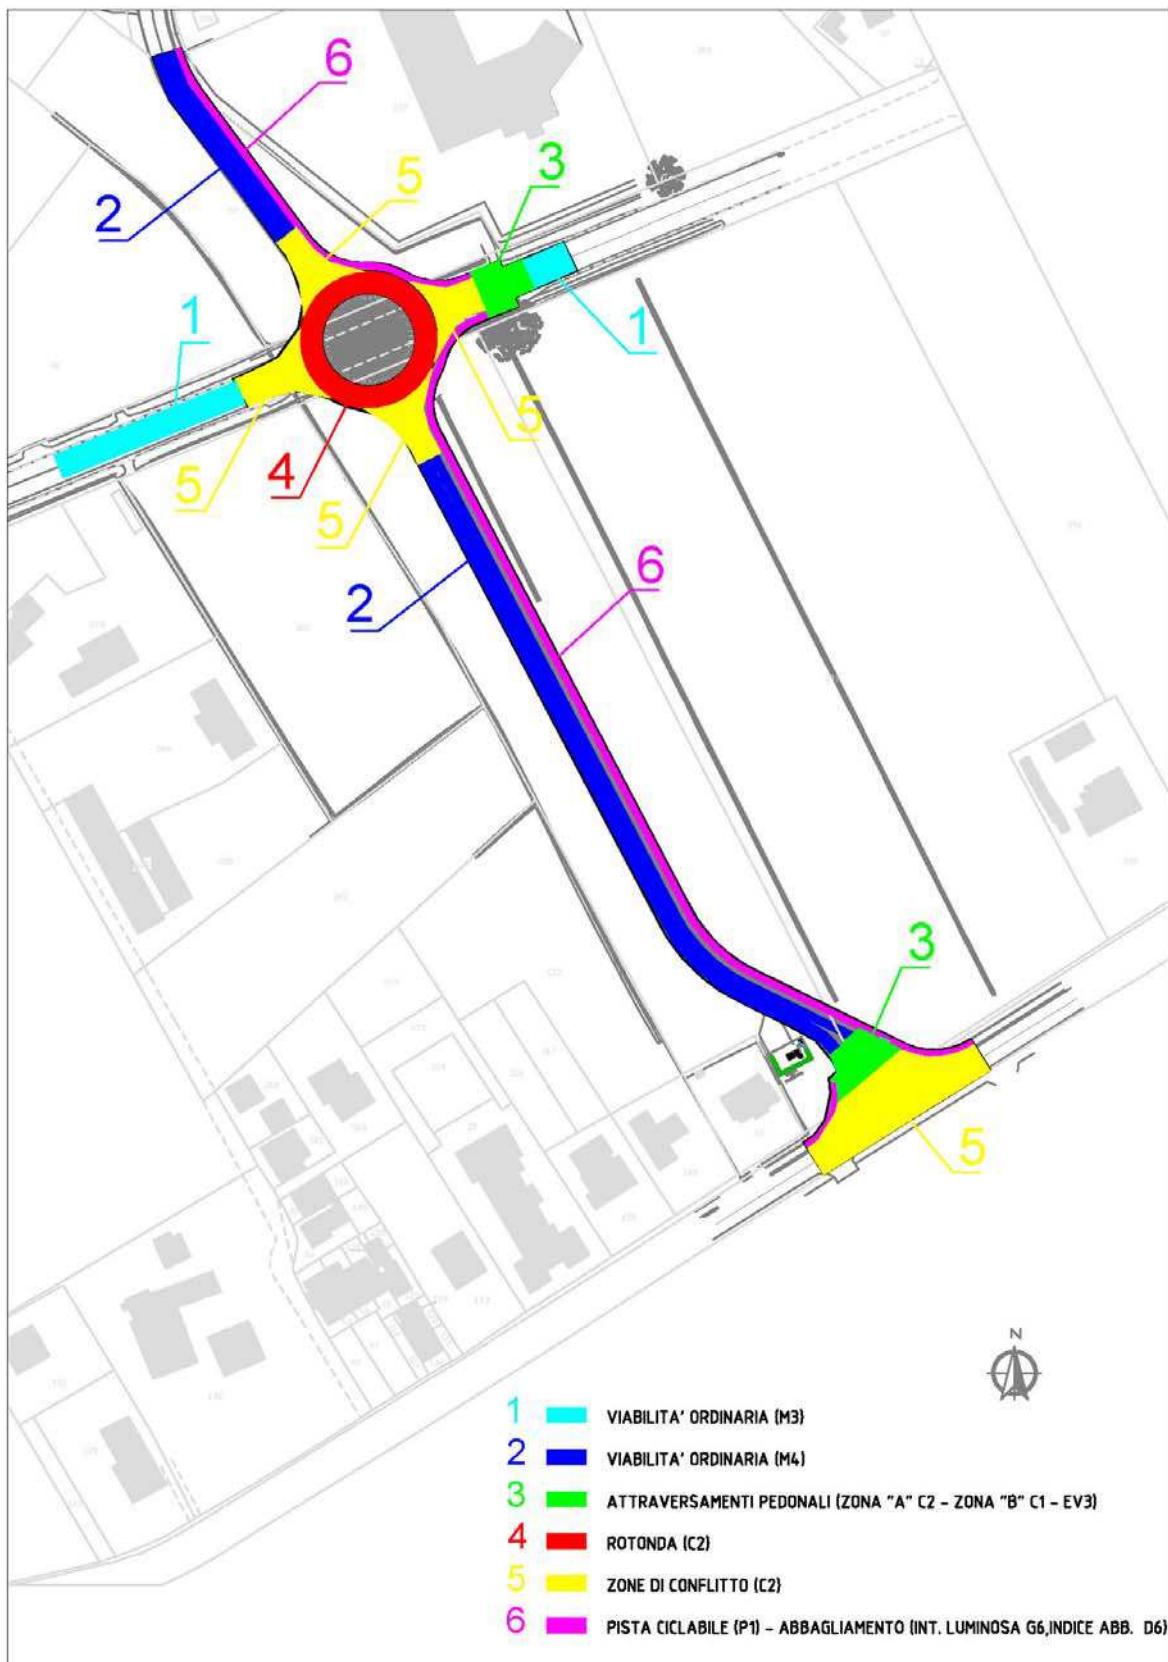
Planimetria con evidenza delle diverse zone di calcolo
